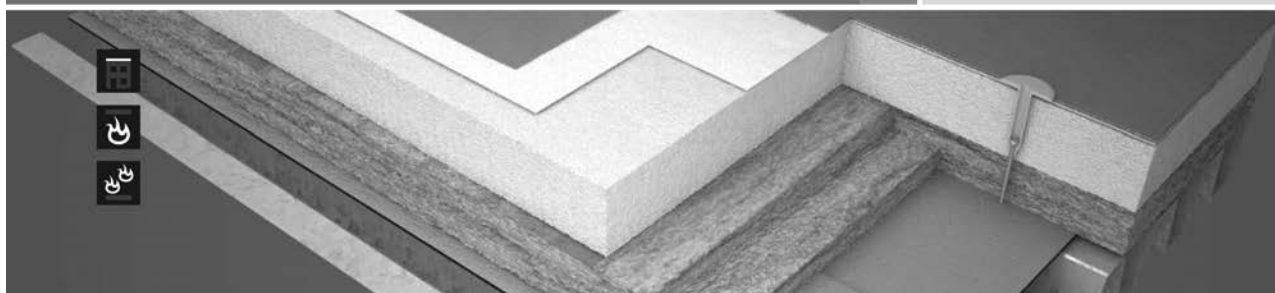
Detail u vtoku (skladba DEKROOF 13-B)
